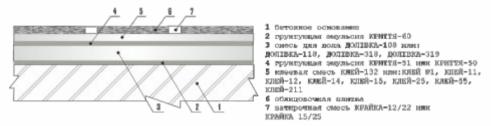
Устройство прослойки пола на ровном бетонном основании.
